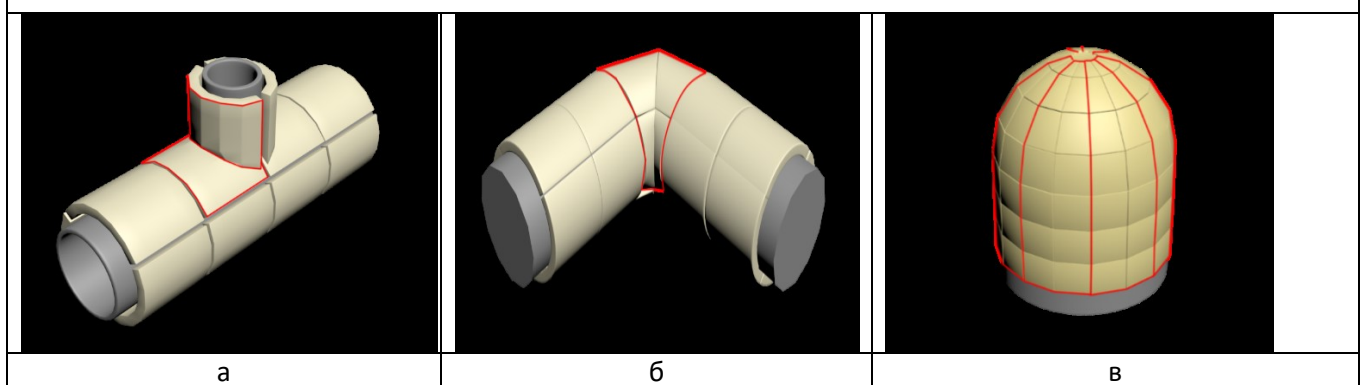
Схема монтажа на сложных (переходных) элементах трубопровода волокнистого теплоизоляционного материала с применением ленты-липучки
